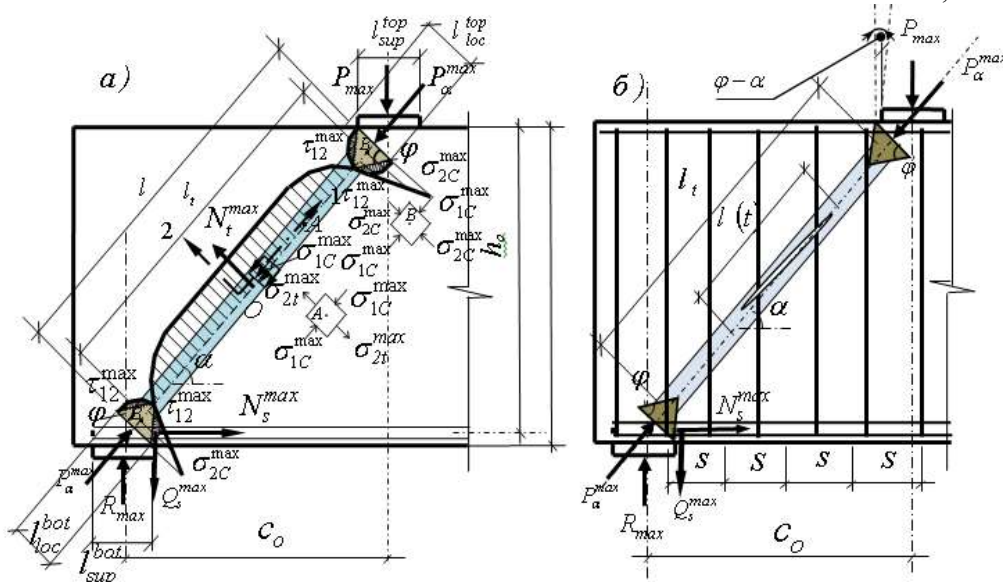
Расчетные модели при малых пролетах среза: а) балки без поперечной арматуры; б) балки с поперечной арматуры (иллюстрация автора)
